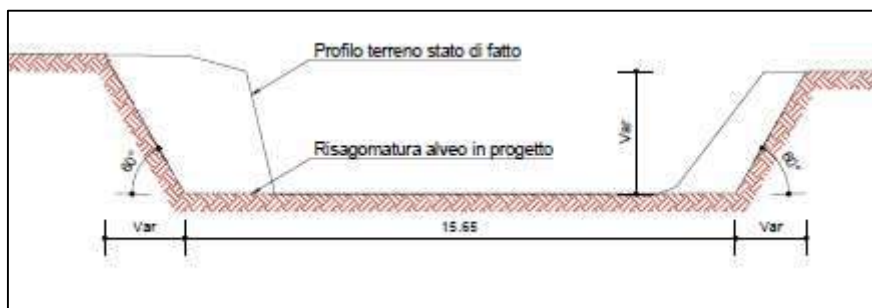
Sezione tipologica sistemazione alveo in progetto
